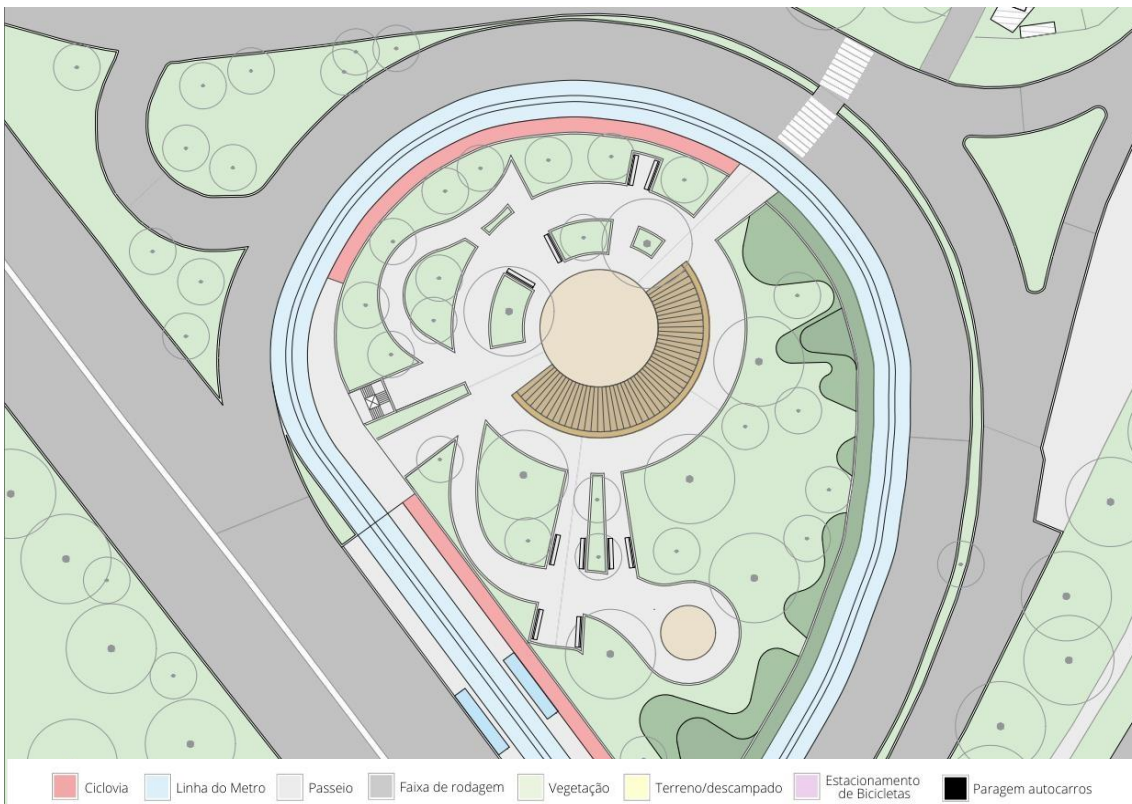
Planta 03 - Leça da Palmeira – Nó A28
